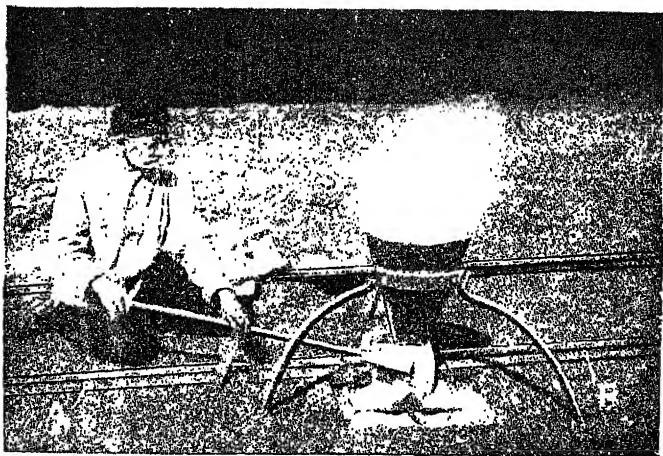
Soudure des rails par l'aluminothermie : vue d'ensemble du dispositif en fonctionnement.
